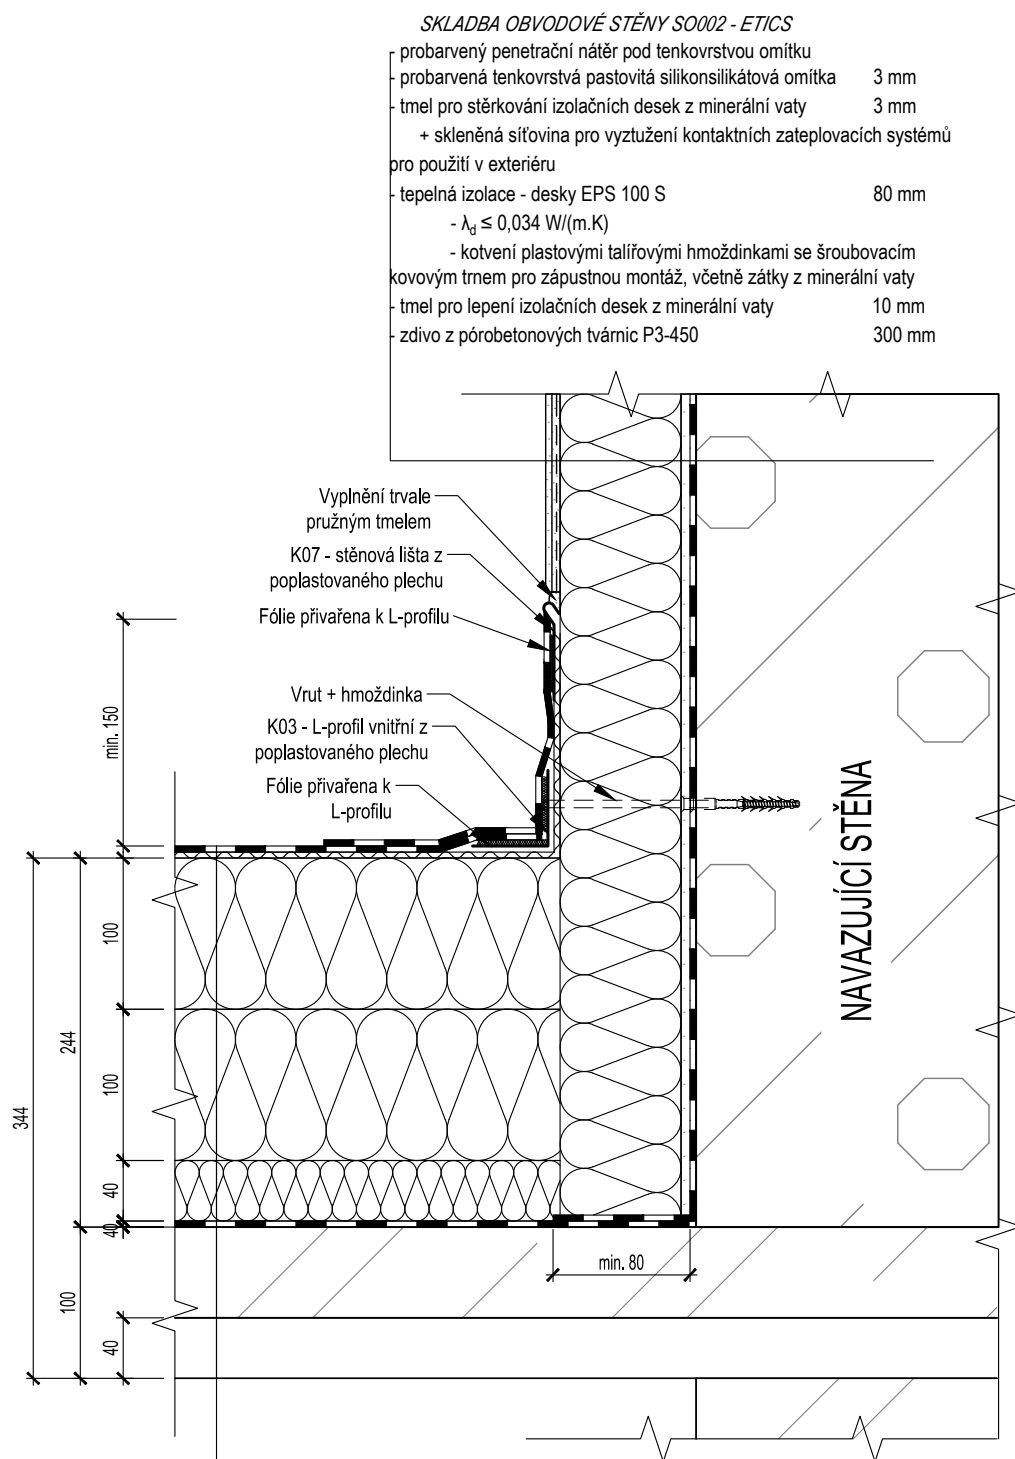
" - POJISTNÝ PŘEPAD STŘECHY
